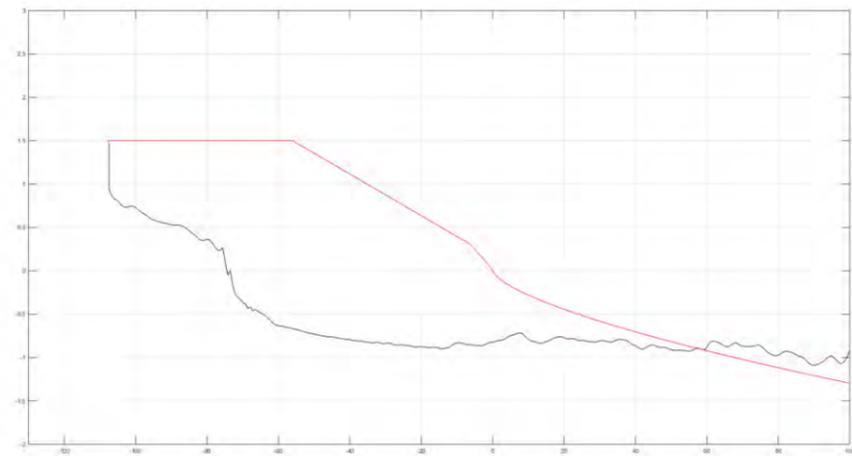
Detalle del Perfil 1, para el cálculo del volumen de aportación en la alternativa 4. Fuente: Elaboración propia.
